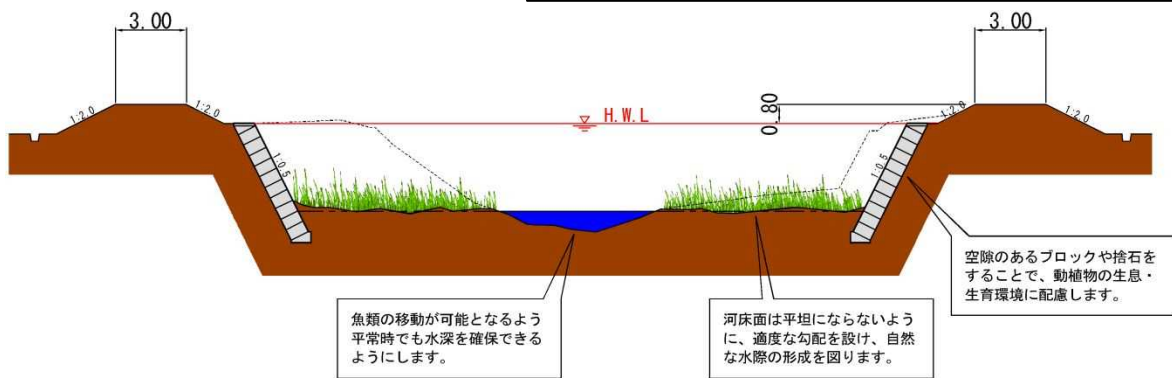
白上川(美濃地地区)横断面図 (長畑堰下流付近)
